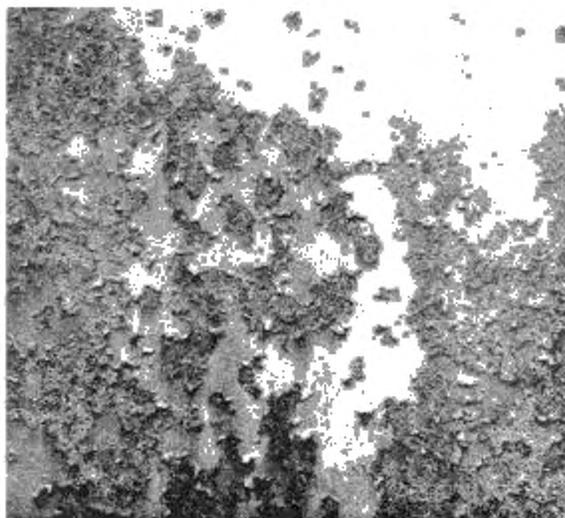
Коррозия металла балл K5 (или Ri 5)
